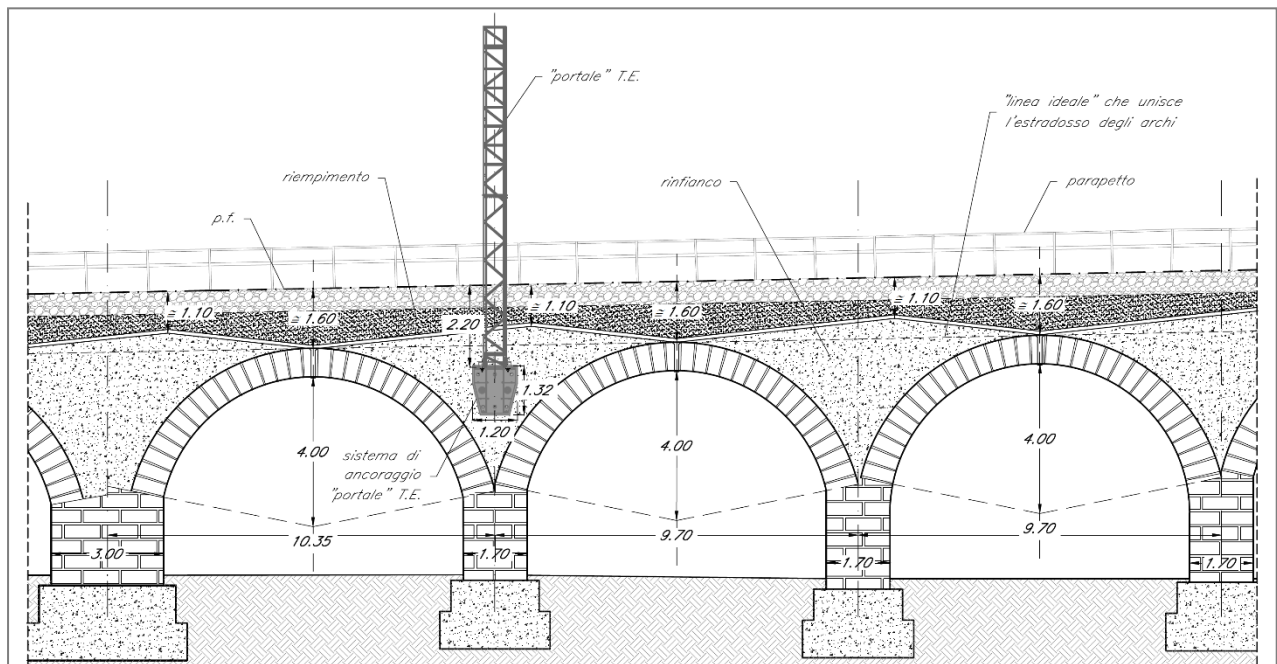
VI01 – Viadotto Gocciadoro: stralcio sezione longitudinale tipo
